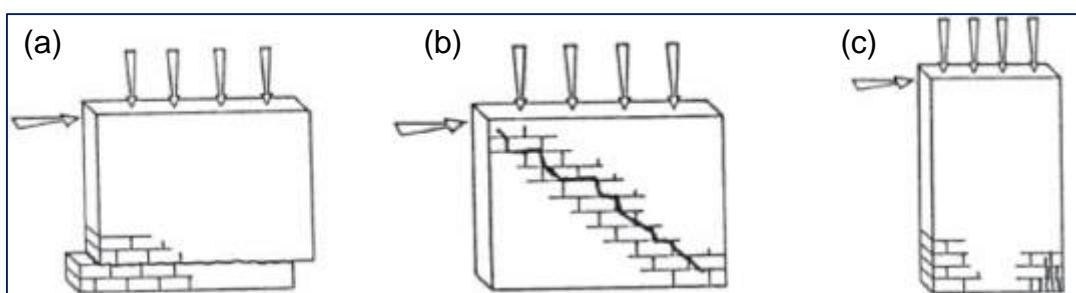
Tipos de falla de albañilería. (a) Falla de corte por deslizamiento; (b) Falla por corte a través de una grieta diagonal; (c) Falla por flexión.
